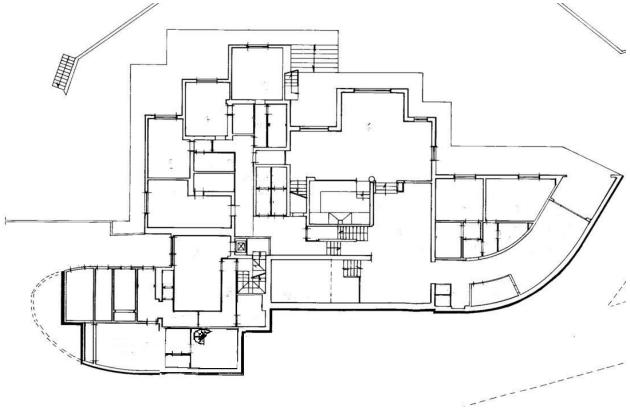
planimetria piano seminterrato (fuoriscala)
